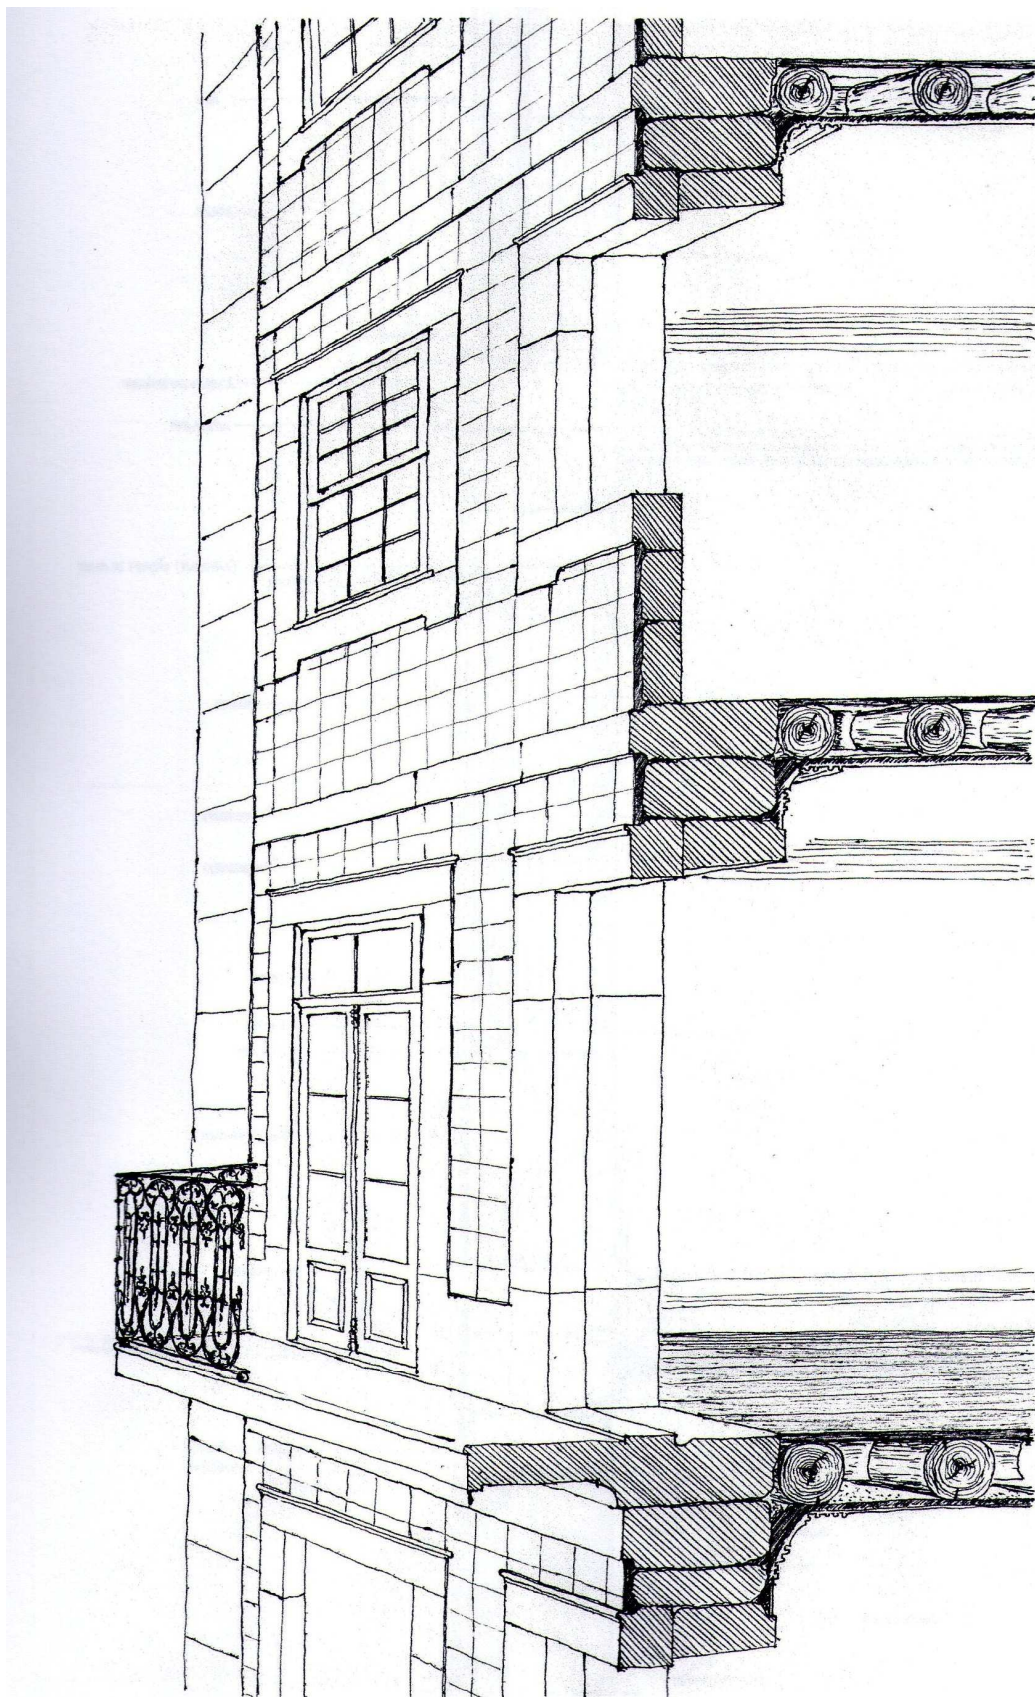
Visualização de um corte de parede de fachada principal e da distribuição da espessura das partes que compõem as paredes (Teixeira, 2004, p. 108).
